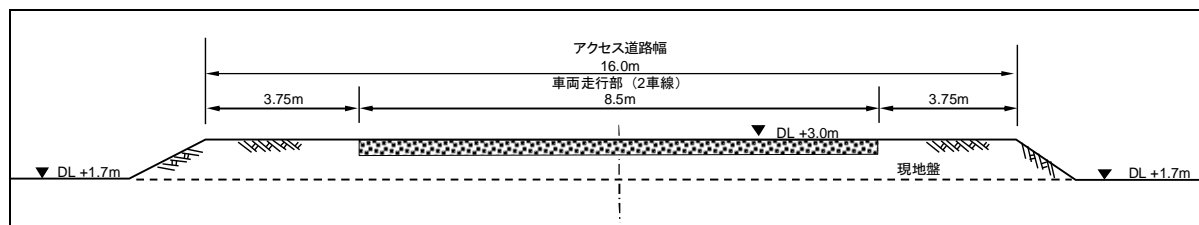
南側アクセス道路の堤防基部陸側の横断面図
